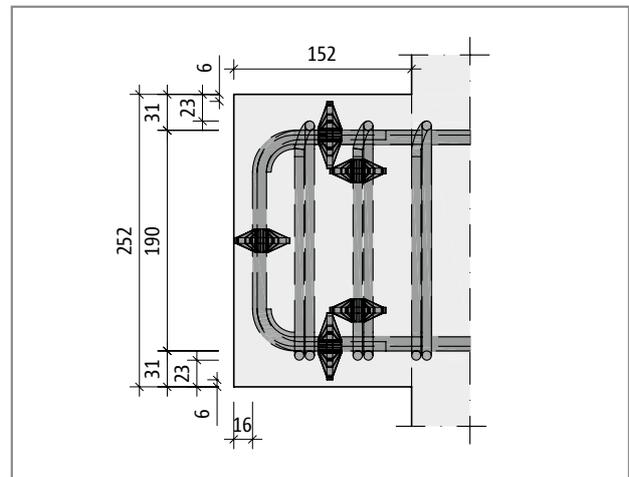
Schöck Tronsole® Typ Z: Grundriss einer Betonkonsole mit eingebautem Tragelement
